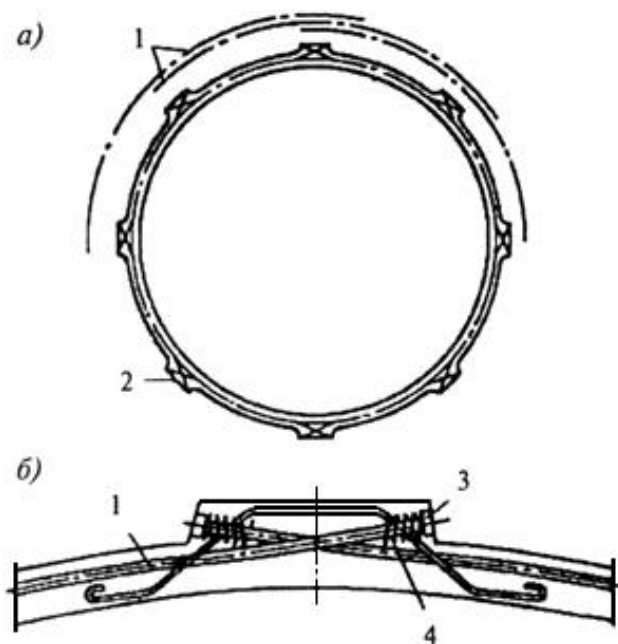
Армирование монолитных и сборных железобетонных куполов и их элементов
